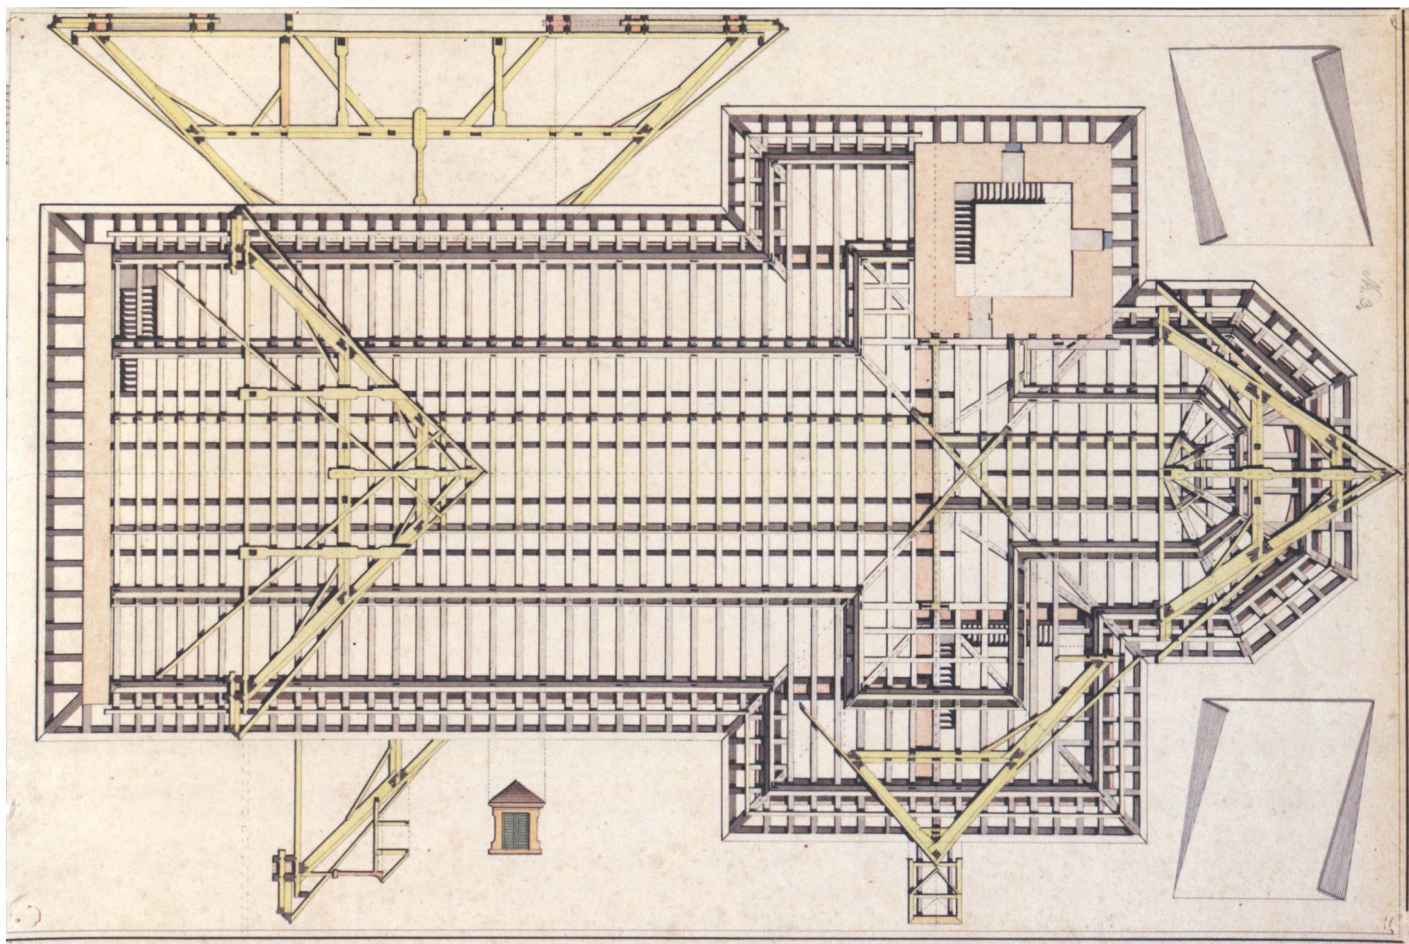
Zulageplan des Dachwerks über der Pfarrkirche Alpnach aus dem Nachlass Jost Kopp's (um 1812. Tinte, laviert. 52 x 35 cm). Mit den Stuhlkonstruktionen über dem Langhaus, dem Chor, den Querarmen sowie über der Vierung. (Nachlass Jost Kopp. Archiv des Schlossmuseums Beromünster. Fotos: Martin Gantner/Jasmin Schäfer, ETH Zürich.)
